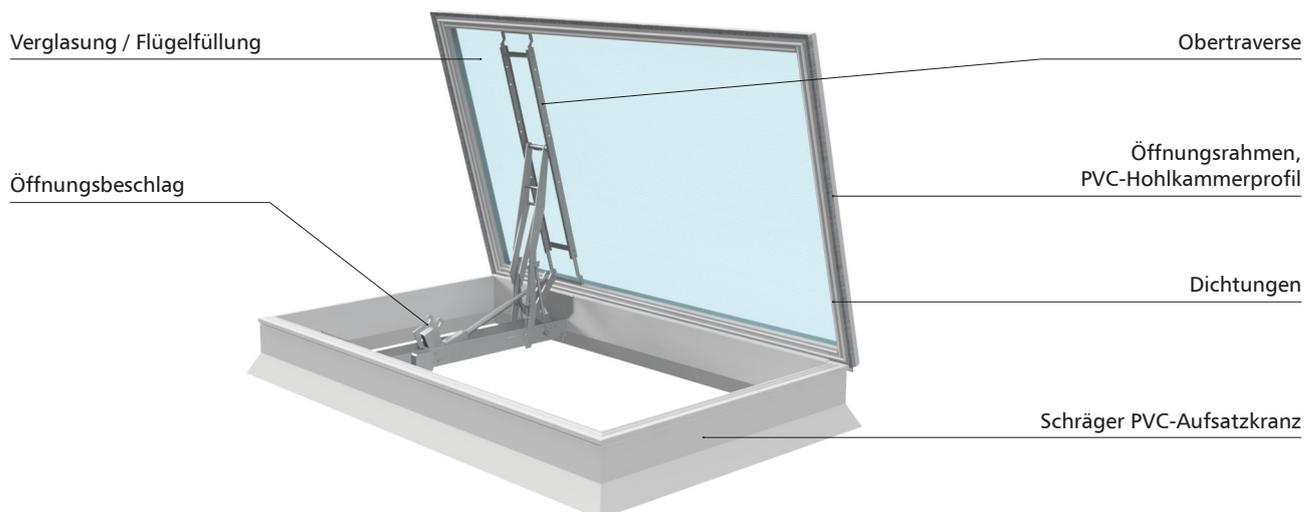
Aufbau eines RWA-Gerätes mcr ULTRA THERM Typ NG-A mit schrägem PVC-Aufsatzkranz in Dachausstiegsausführung, mit einem seitlich montierten Elektroantrieb
